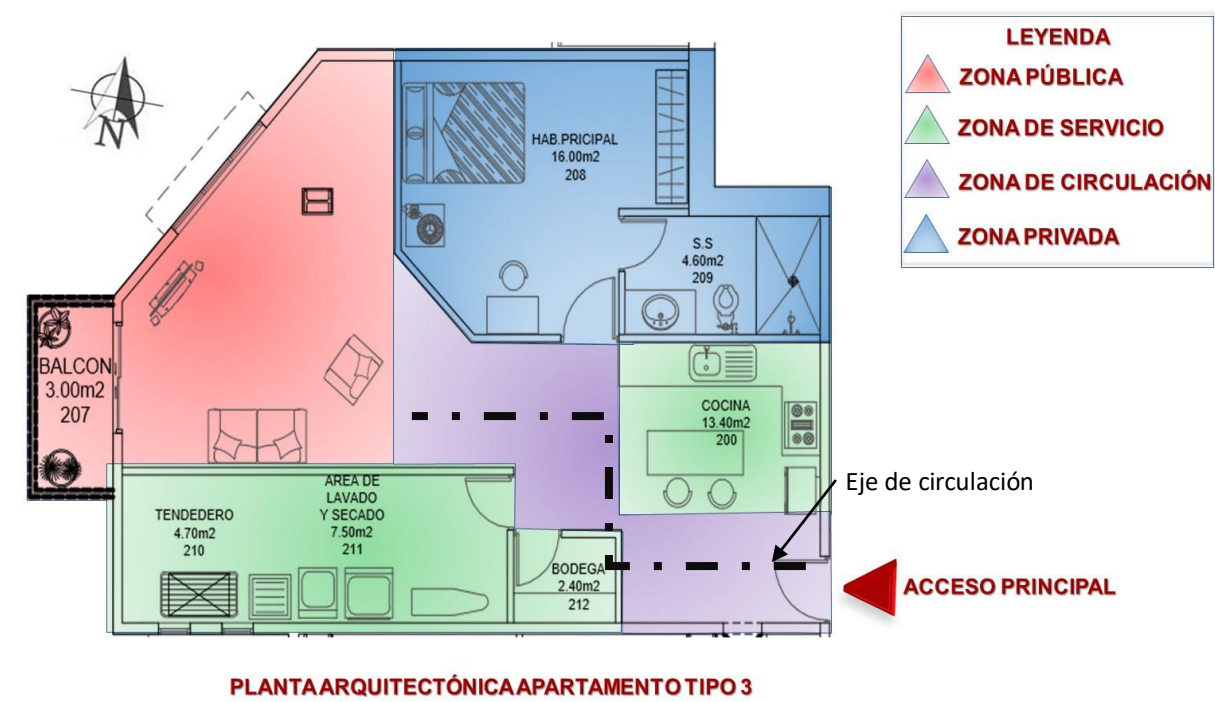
Planta arquitectónica del apartamento tipo 3
